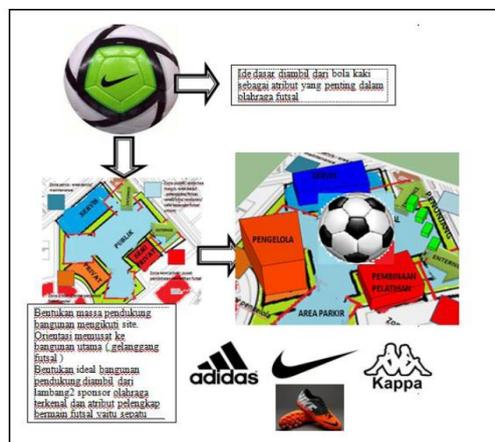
Konsep orientasi dan sirkulasi bangunan futsal center di Pontianak
